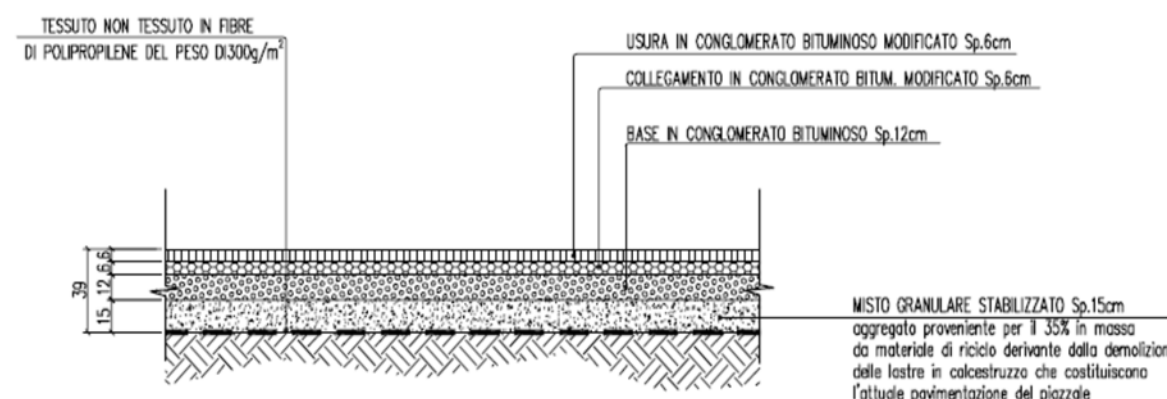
DETTAGLIO PAVIMENTAZIONE FLESSIBILE
